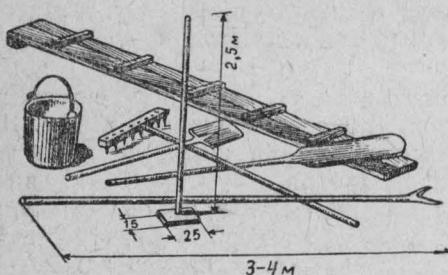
Инструменты для работ по покрытию глино-соломенной кровли.
